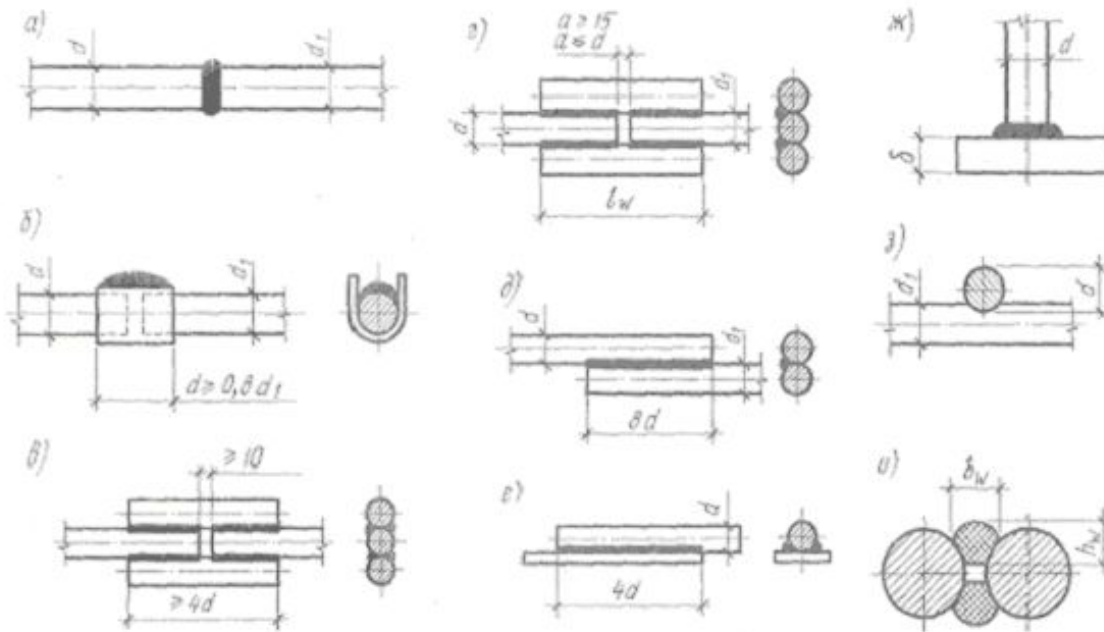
Сварные стыки ненапрягаемой арматуры:
